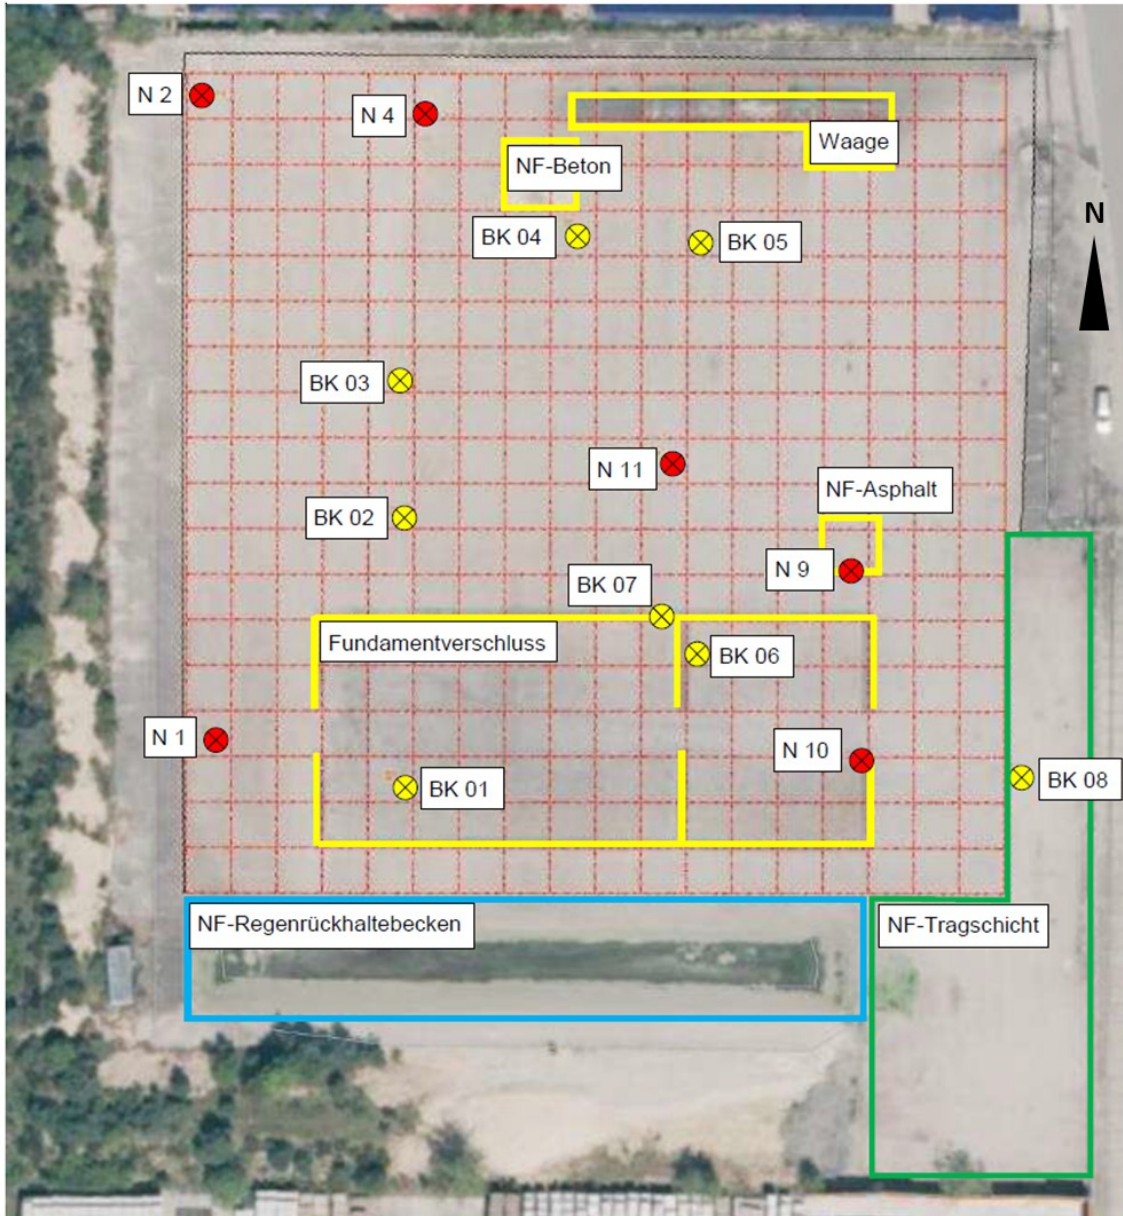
Lageplan mit Hauptfläche (rotes Raster) und Nebenfläche (grün eingerahmt)
